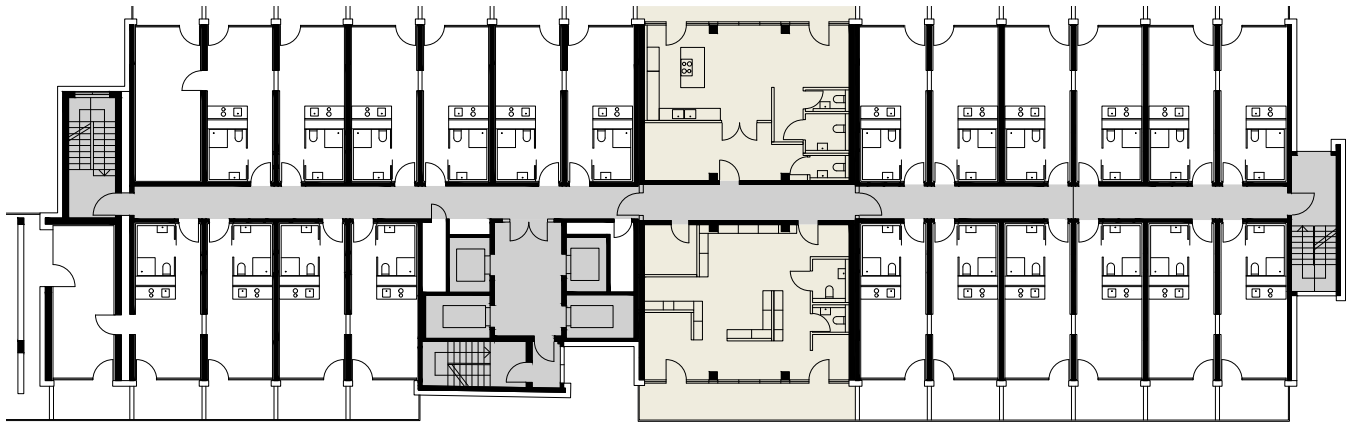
Grundriss Regelgeschoss, M 1:375 [© BF Vario]
